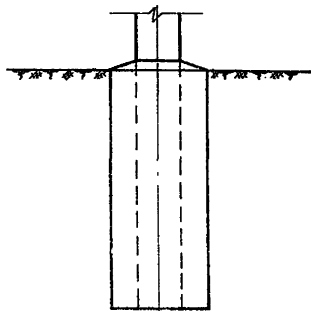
<sup>а</sup>. Специальное закрепление в бетонируемом котловане
